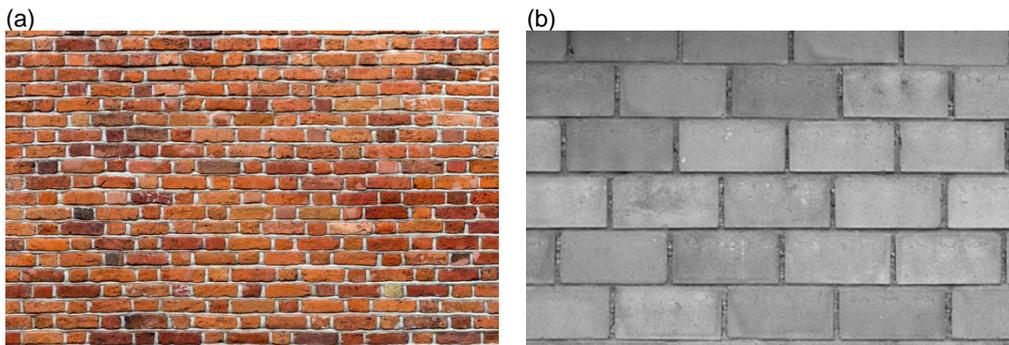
Ejemplo de muros de fábrica sin armar: a) ladrillo, b) bloque de hormigón.
